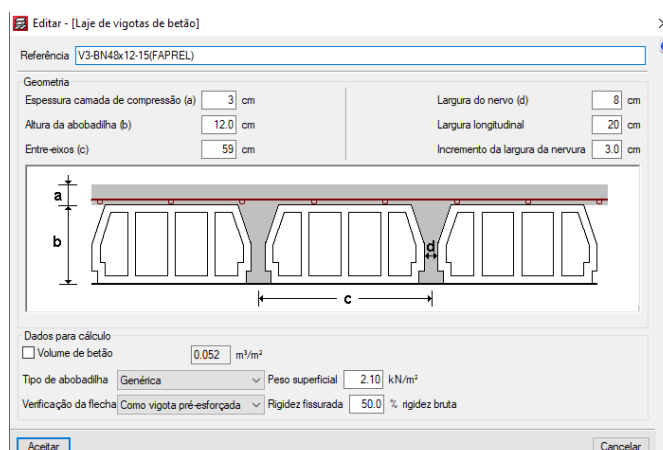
Laje de Vigotas da Cobertura da Cozinha (Fonte: CYPE)
